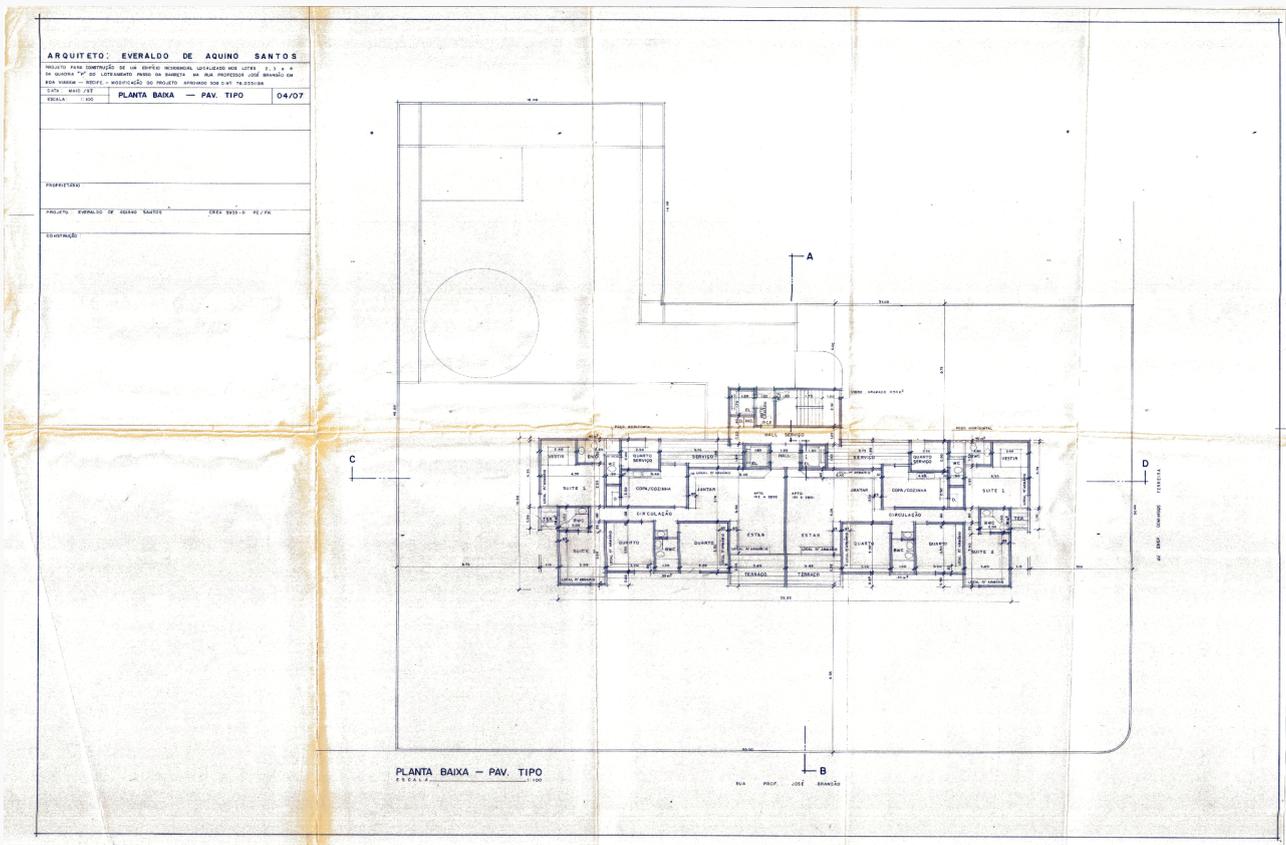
Planta Baixa original do Edifício Rio Sena.
